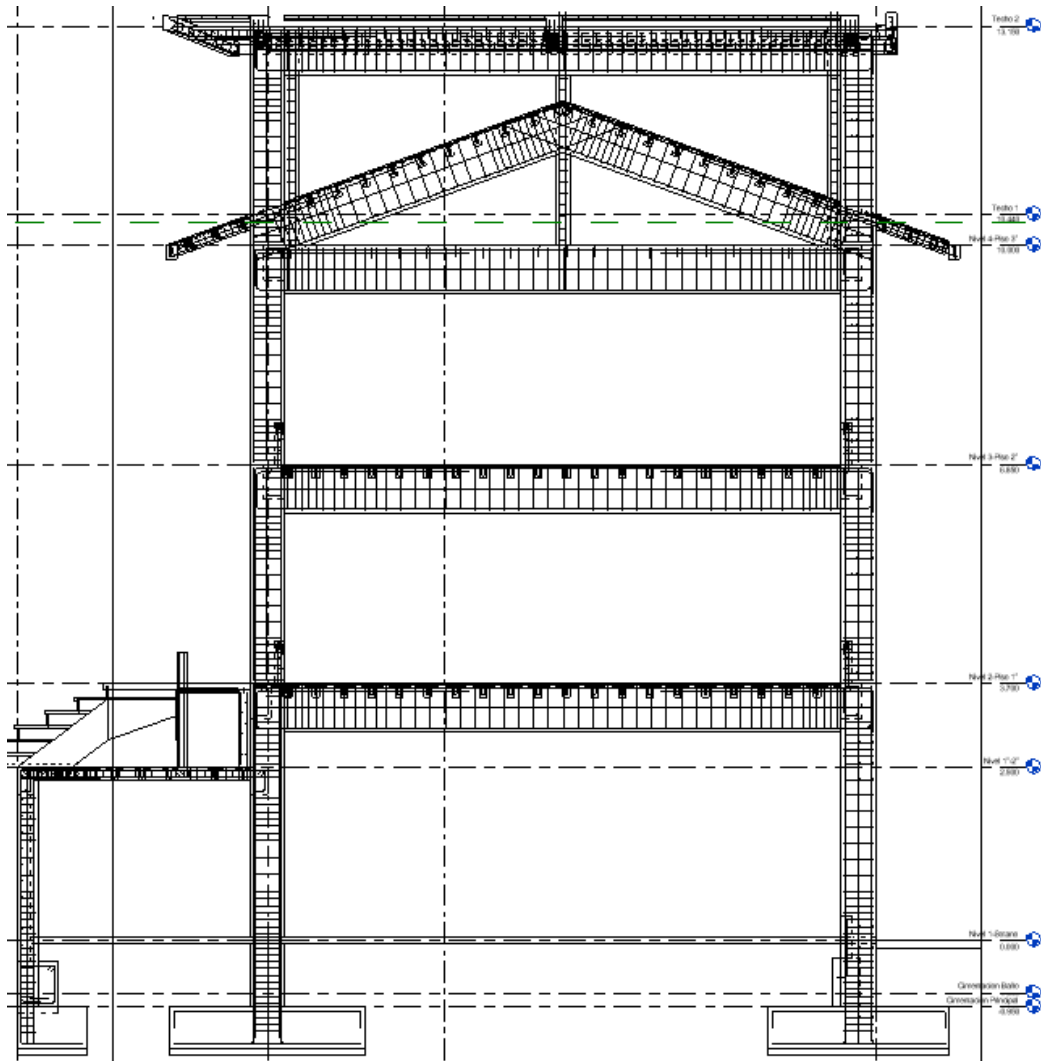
Armazón estructural - Eje 3-3. Fuente: Autor
